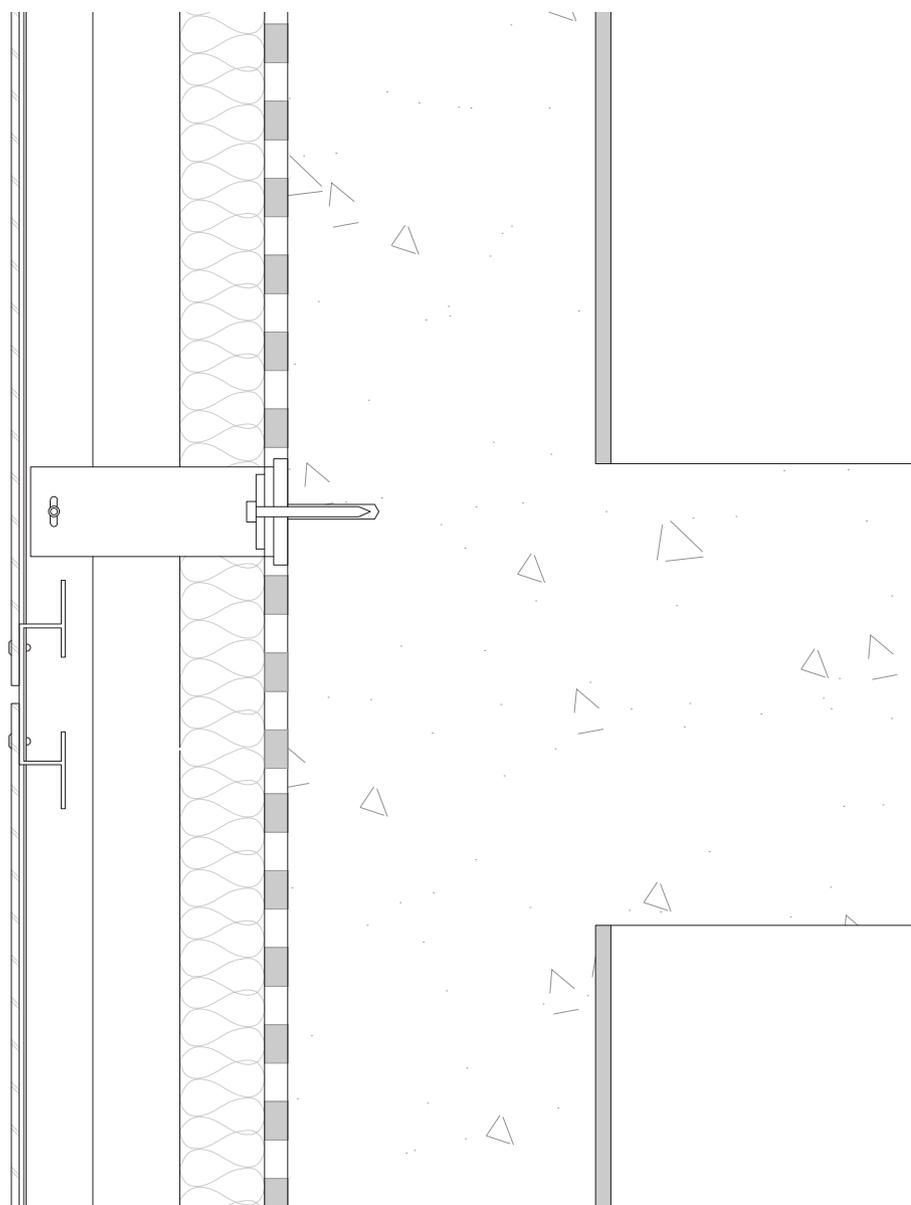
Pormenor construtivo, fixação dos painéis -Corte.
